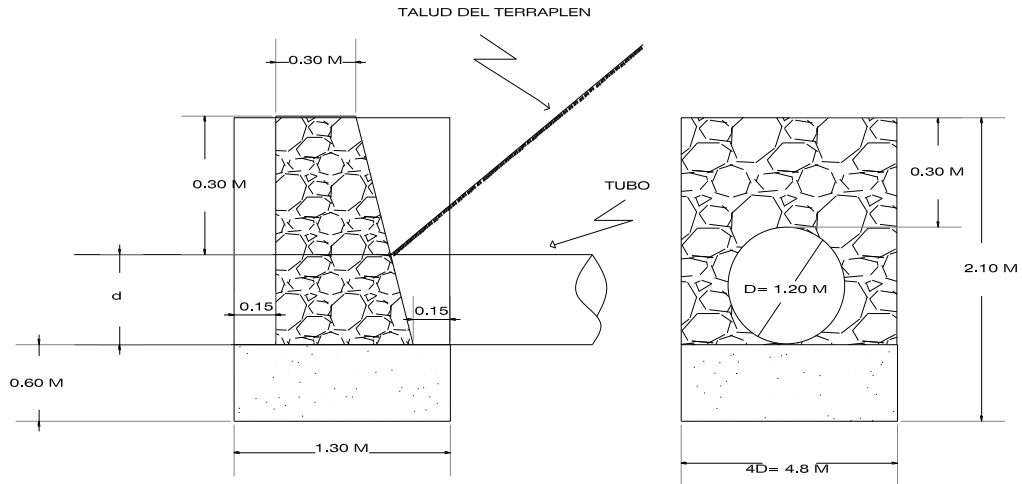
Muros de cabeza para alcantarilla de tubo 2.
